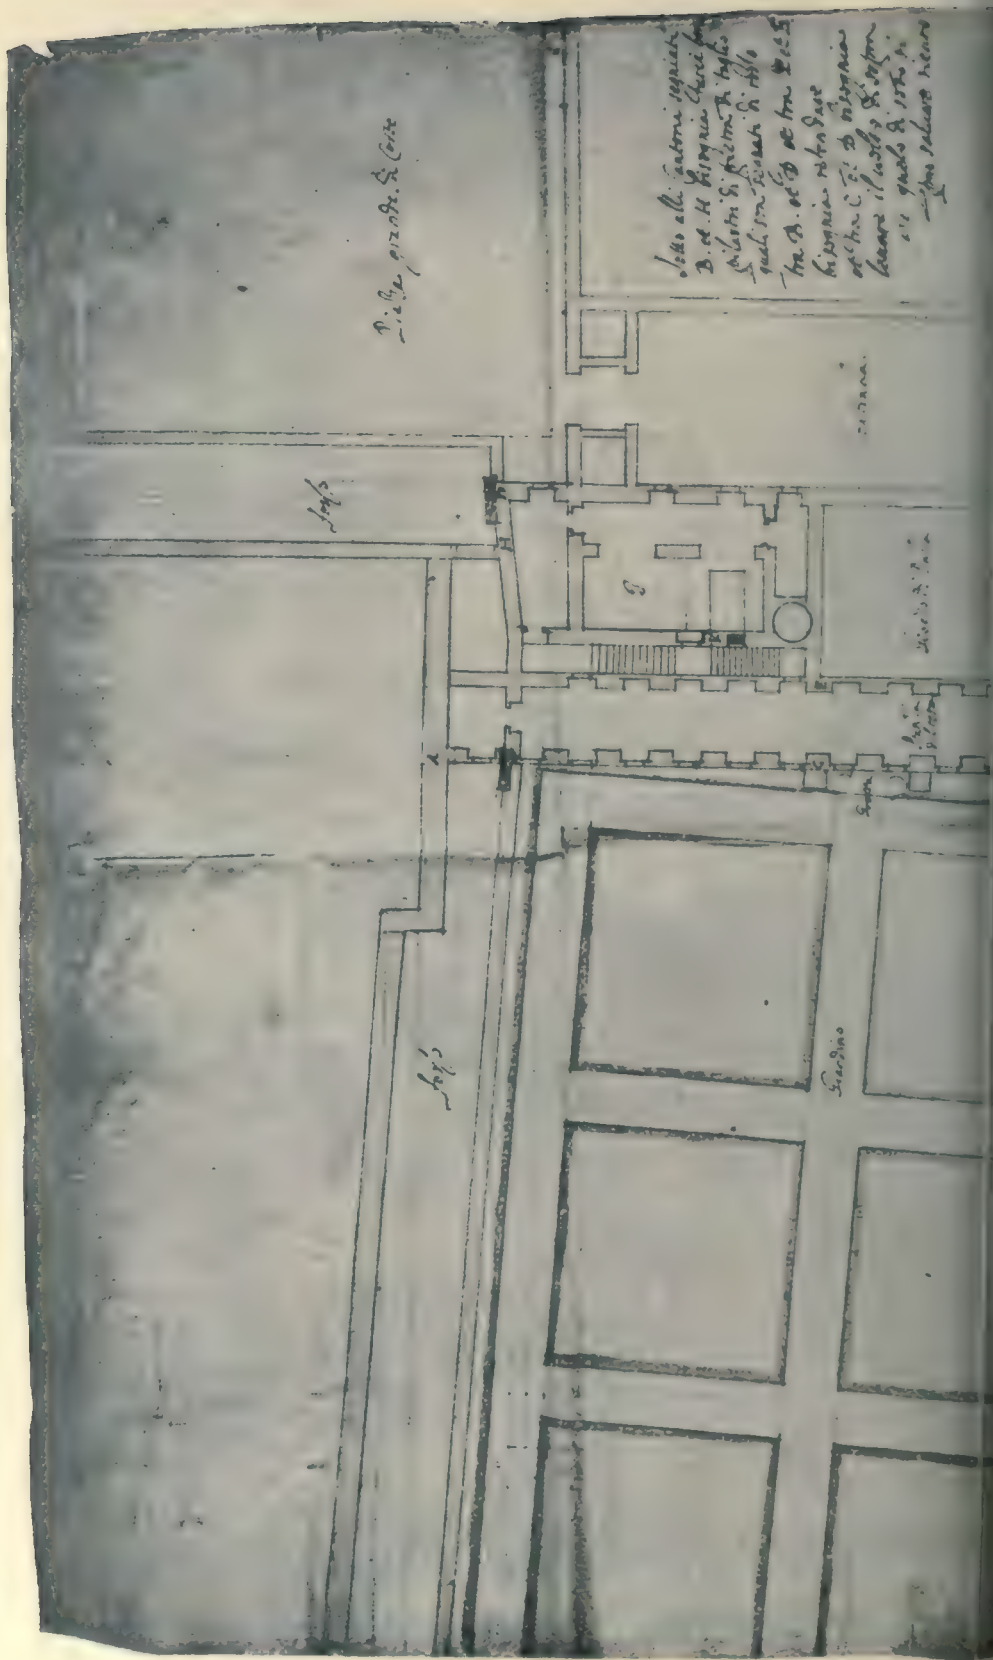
Grundriß des Hofgartens mit Ballhaus, aus den Jahren 1640—41, Federzeichnung, zum Teil farbig laviert,
